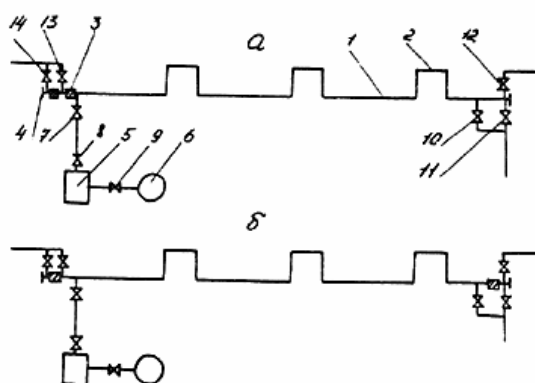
Принципиальная схема испытания трубопровода подогретой водой:
